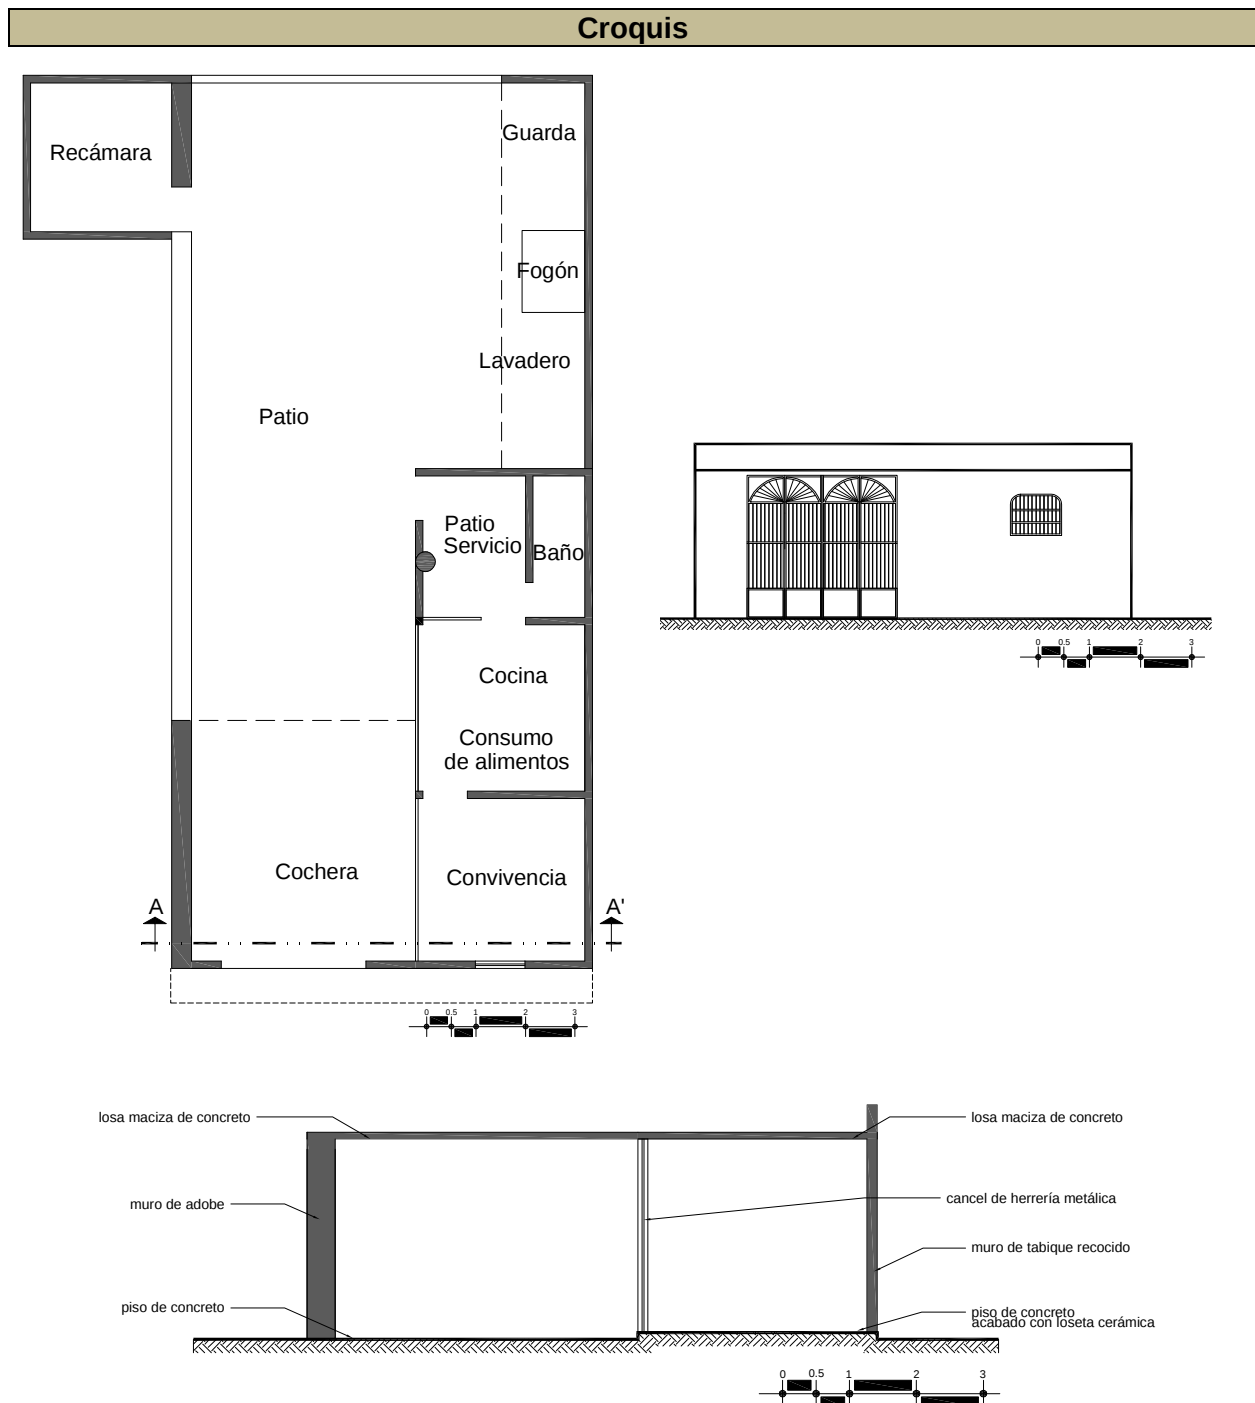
Distribución espacial en planta, fachada, corte y sistema constructivo de la vivienda tradicional contemporánea. Fuente: croquis y fotografía aportación de la autora con base en levantamientos hechos en sitio.
